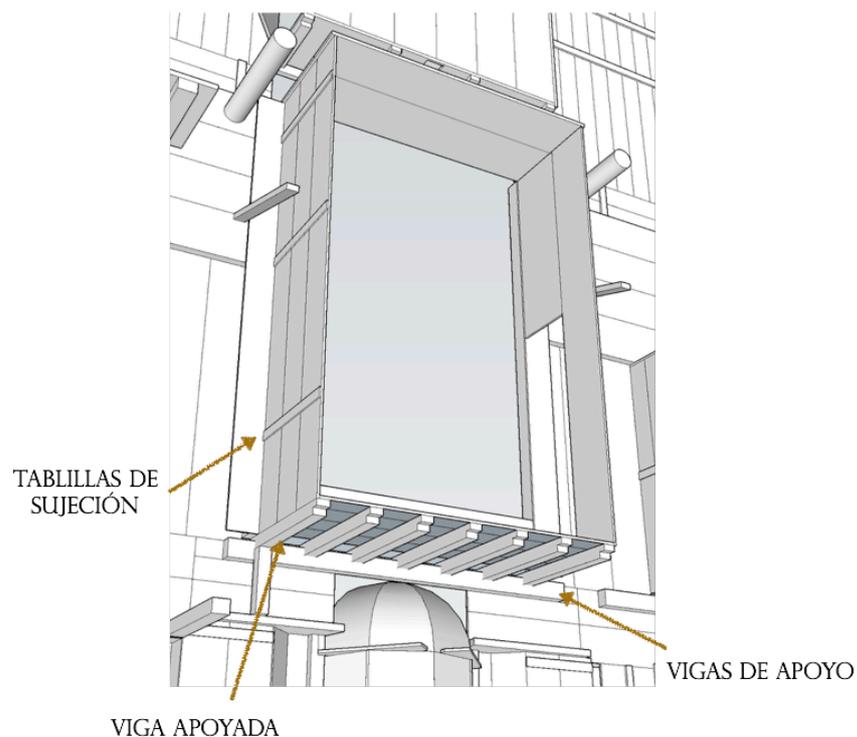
Hornacina central. De forma rectangular, descansa sobre 7 vigas apoyadas, reforzada en uno de sus lados con un pilar que descansa sobre otra viga de apoyo. La hornacina no tiene fondo de madera, por tener antiguo acceso al camarín. Fuente: de la autora.
